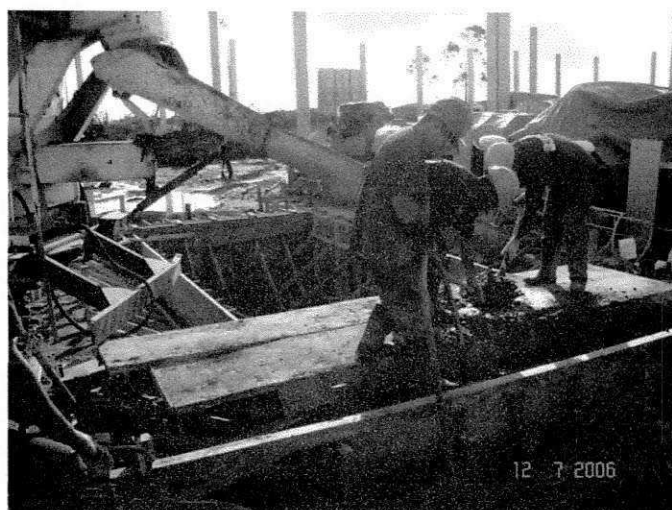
Concretagem das Paredes Laterais da Base dos Moinhos
